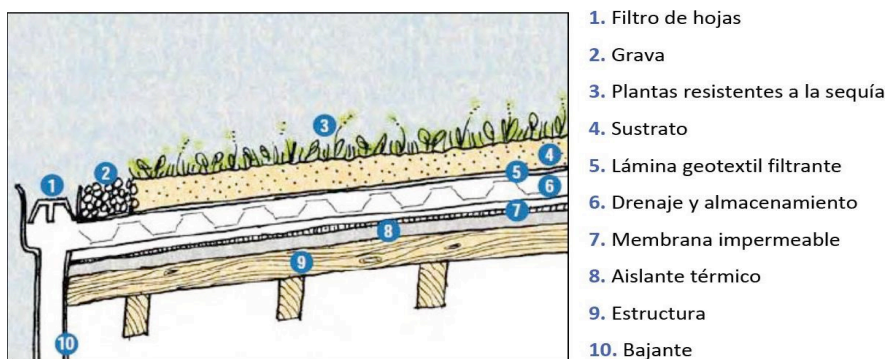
Esquema de una cubierta vegetada. Fuente: SFPUC, (2010). Stormwater Design Guidelines.
